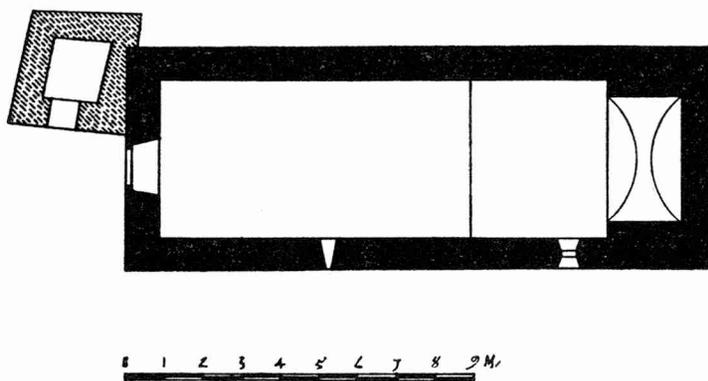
Zanigrad in Istrien. Grundriß der Dorfkirche
